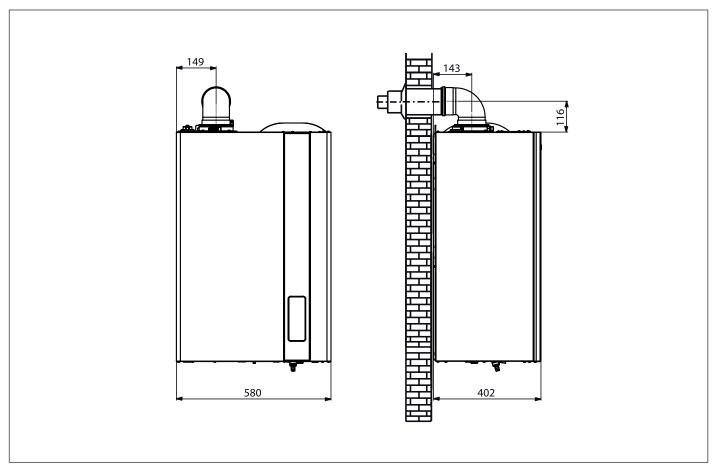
Type C12 - C33 coaxial pipes dimensione
